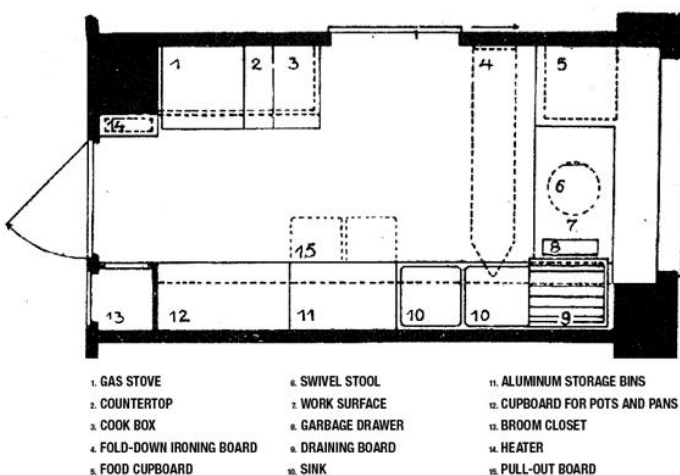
Grete Schütte-Lihotzky, Plano de la cocina Frankfurt, 1926-1927.
